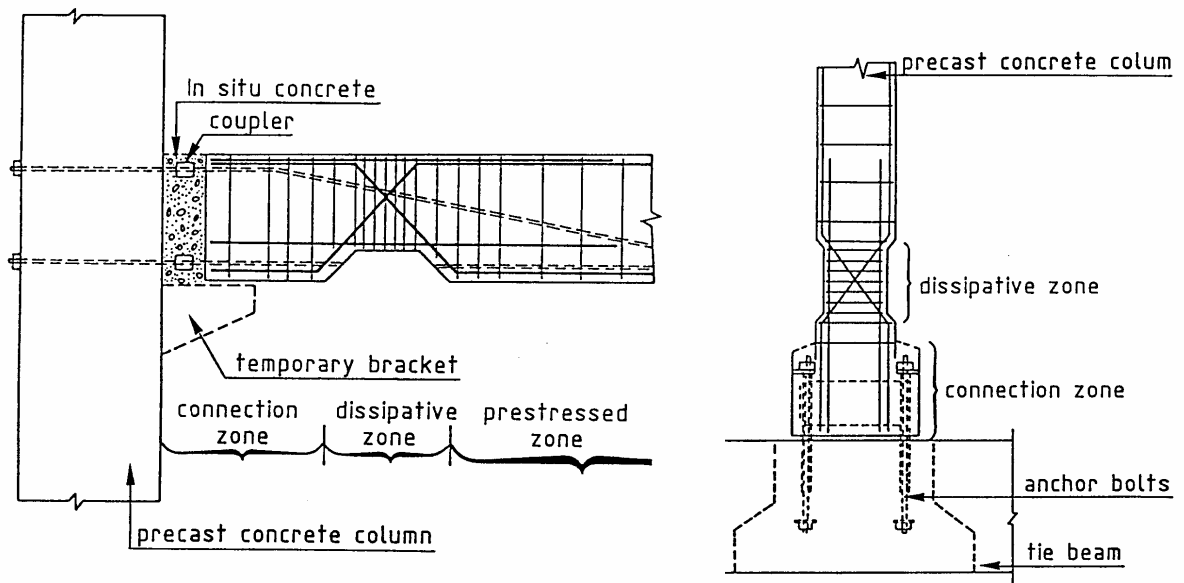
Zone dissipative provoquée. A gauche en bout de poutre. A droite en pied de poteau.
